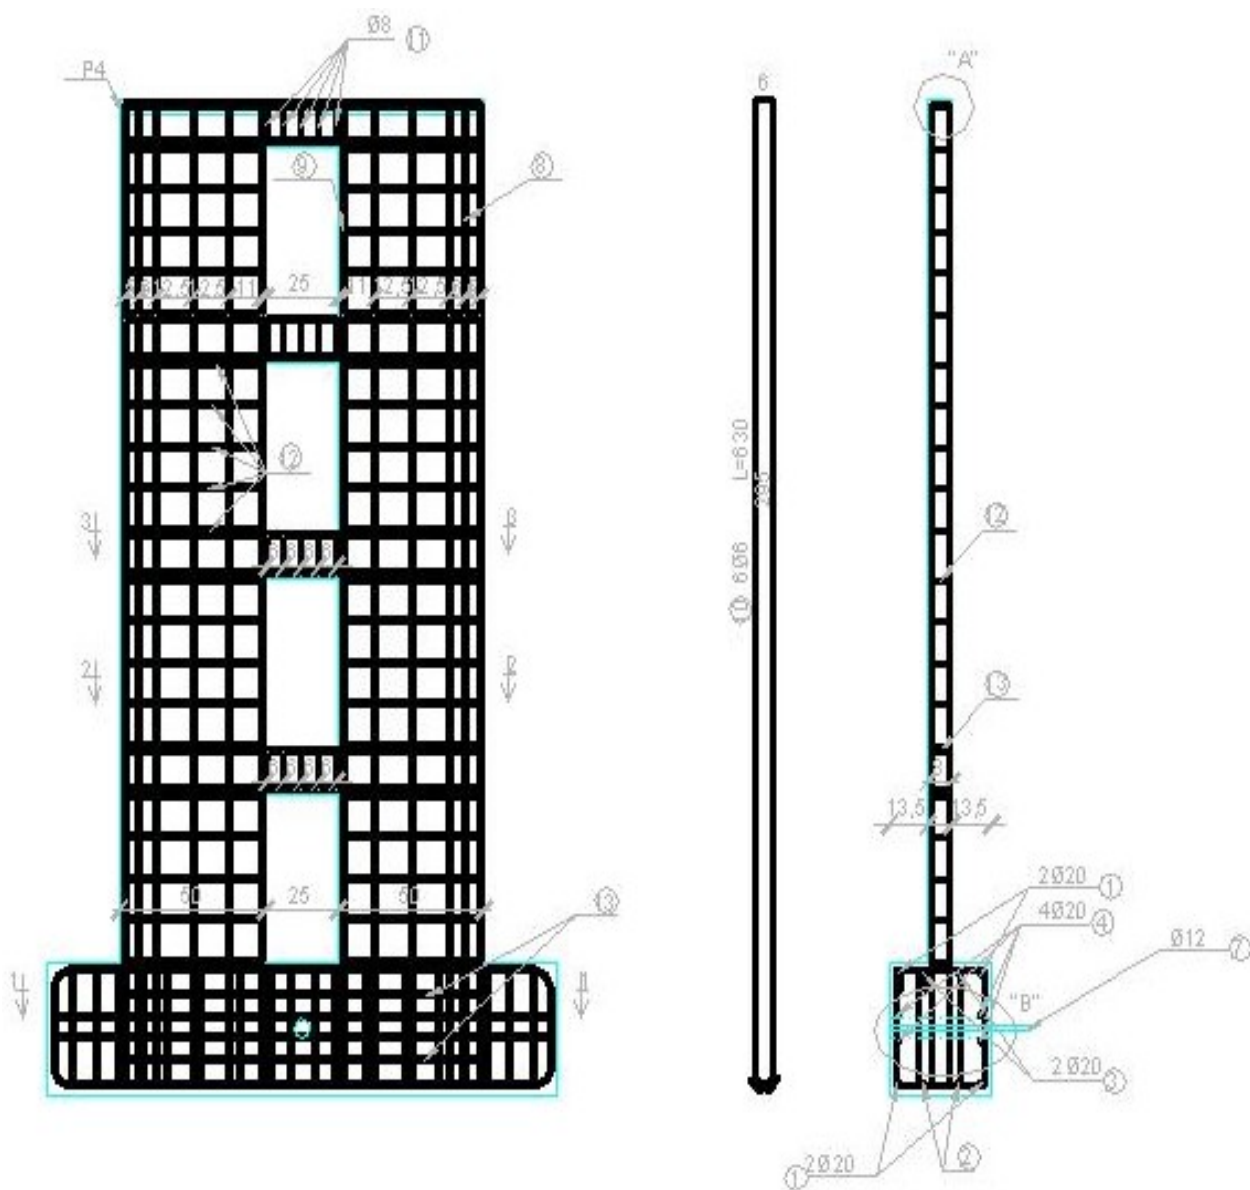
Plan armare perete structural SW8, realizat cu "PMB"
